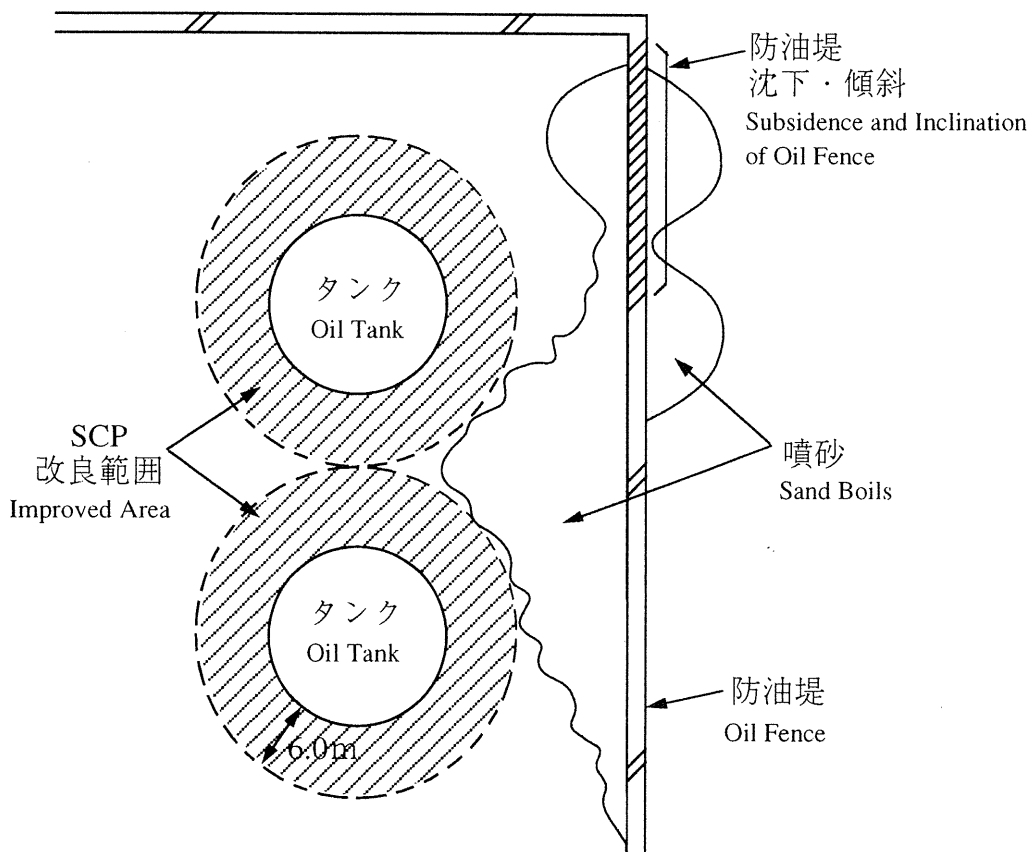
タンク周辺の地盤改良および噴砂の状況
